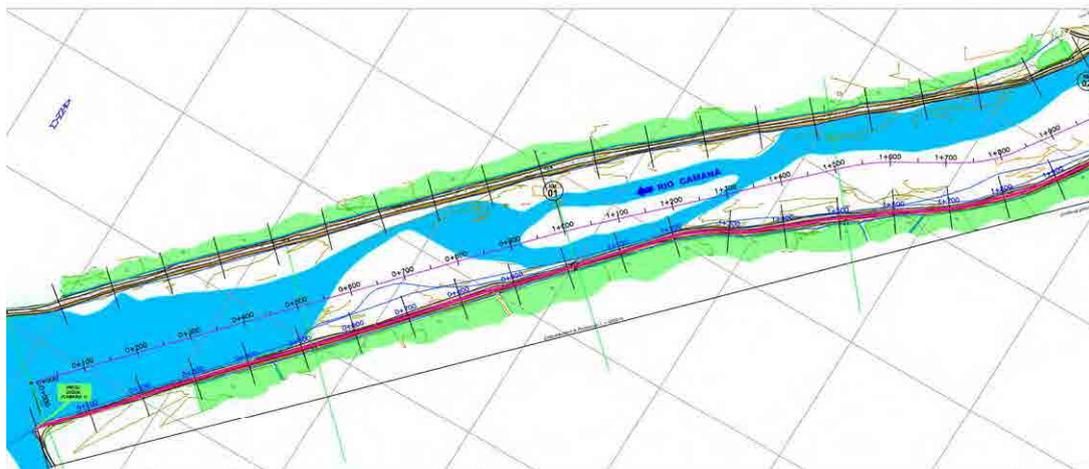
Planta de instalaciones Caman-1 (2)
